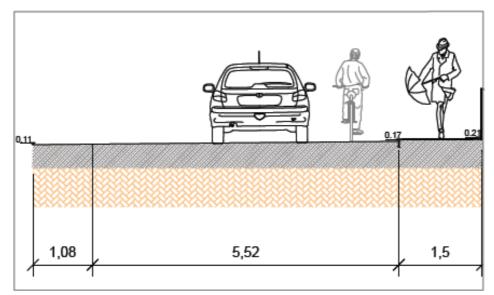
Stralcio pianta via S.G. Bosco e sezione tipo zona 30
